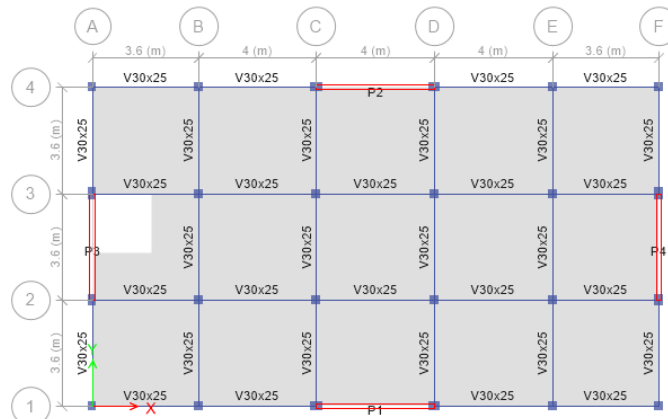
Representación estructural Piso 1 a 5 - Muros
